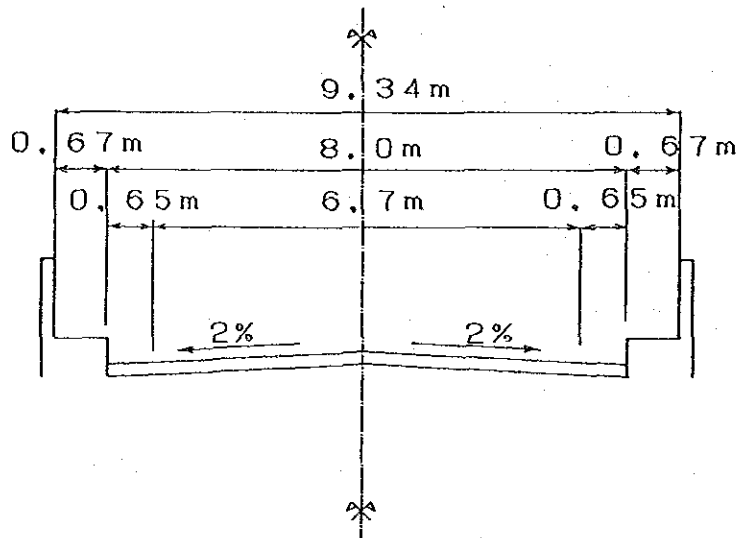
Sección Transversal de la Carreterra y Puente
